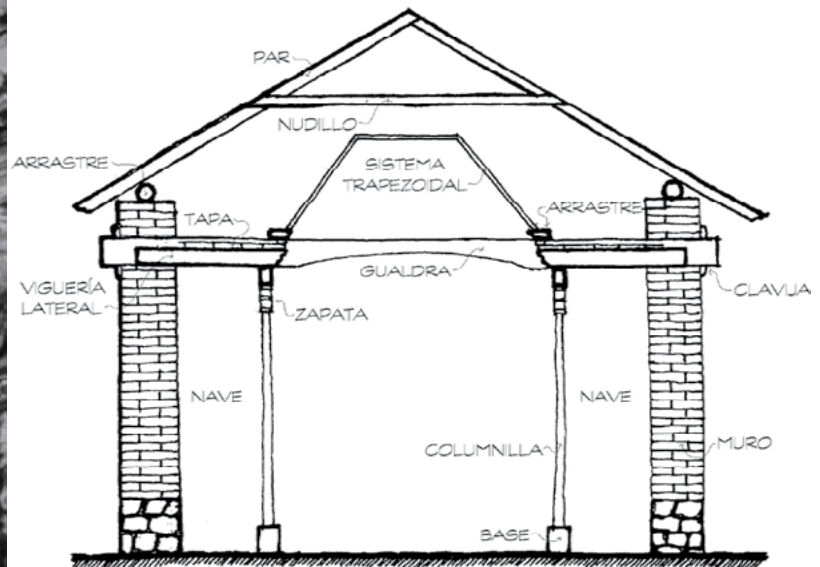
Cubierta trapezoidal de madera, templo de Santa Rosa, en Zacán, Sierra purépecha. Fotografía del Archivo Torres Salomao. Esquema elaborado por Luis Alberto Torres.
